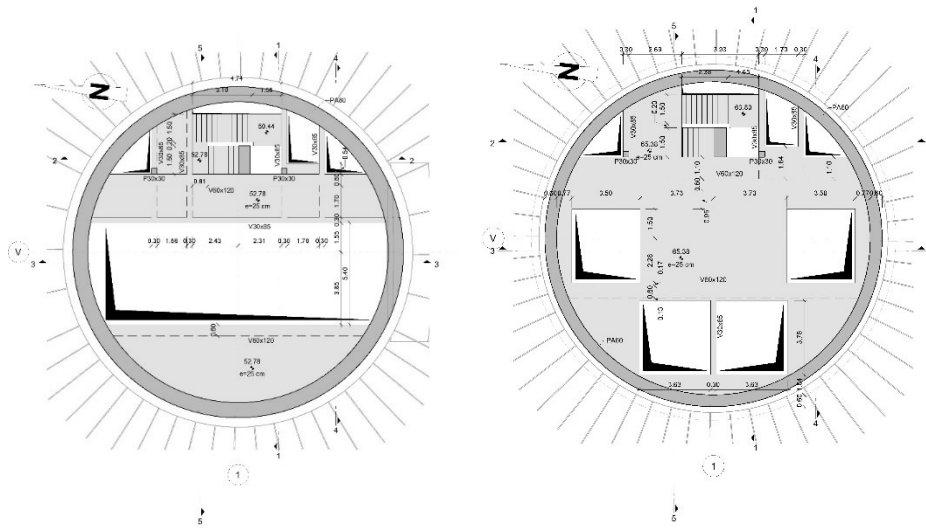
Planta tipo da estrutura definitiva do poço.
